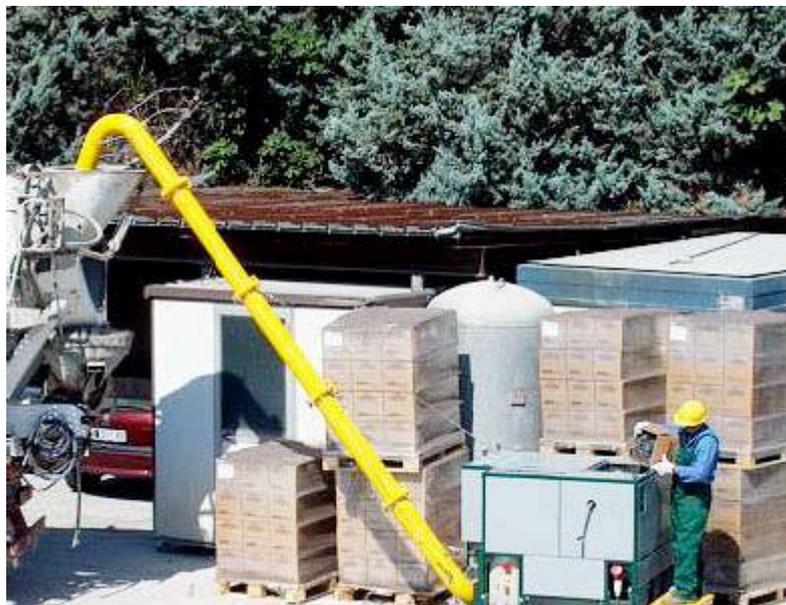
Foto B: Transporte automático de las Fibras de Acero hasta la concreteira.
